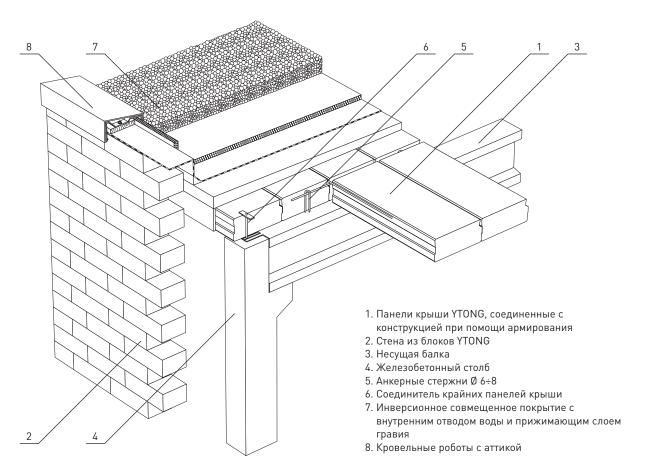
Инверсионная кровля с использованием плит покрытия YTONG – зона примыкания к парапету
